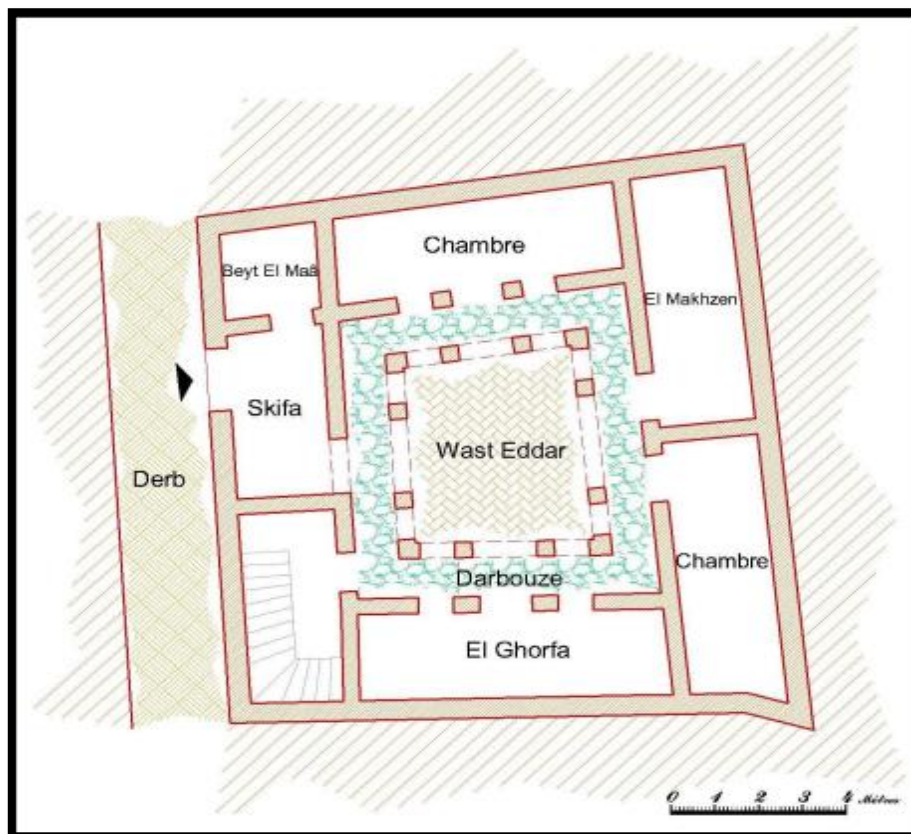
plan de rez de chaussée de la maison n23, dar el baroudi.
